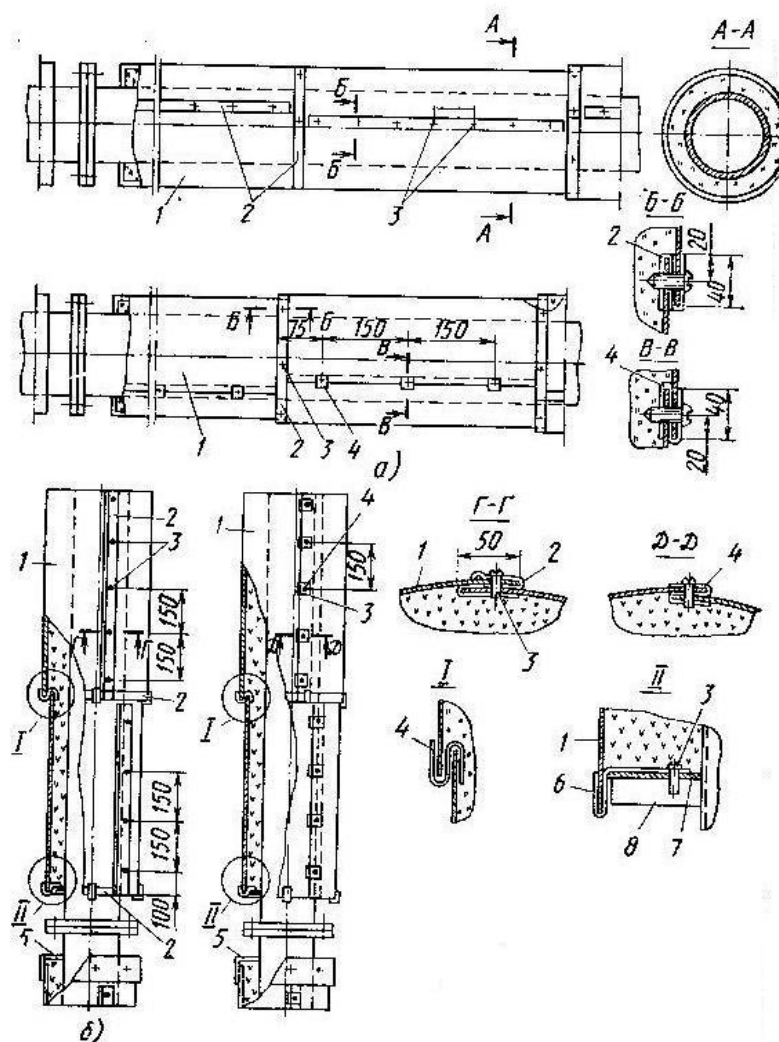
Покрытия изоляции упругими оболочками горизонтальных (а) и вертикальных (б) трубопроводов:
